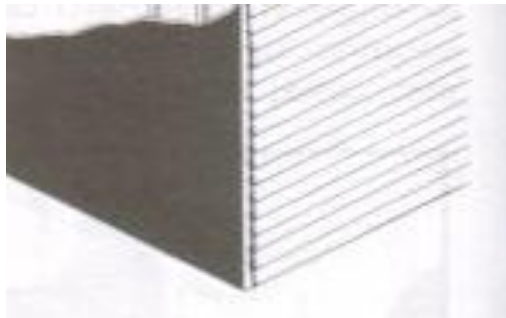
Lado izquierdo, papel Kraft. Lado derecho, pared instalada con piezas Siding Plycem.
